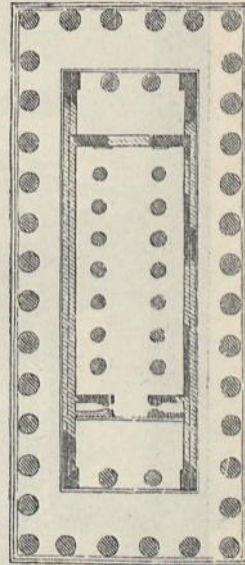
Grundriss des Poseidontempels zu Pästum.
